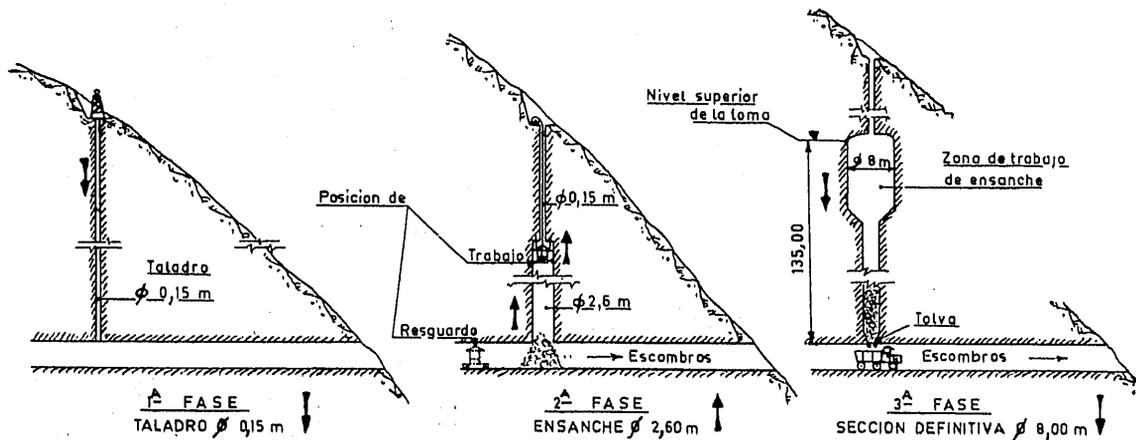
^a — Esquema de la excavación de los pozos para las conducciones forzadas de la central hidroeléctrica de Stornorrfors.
